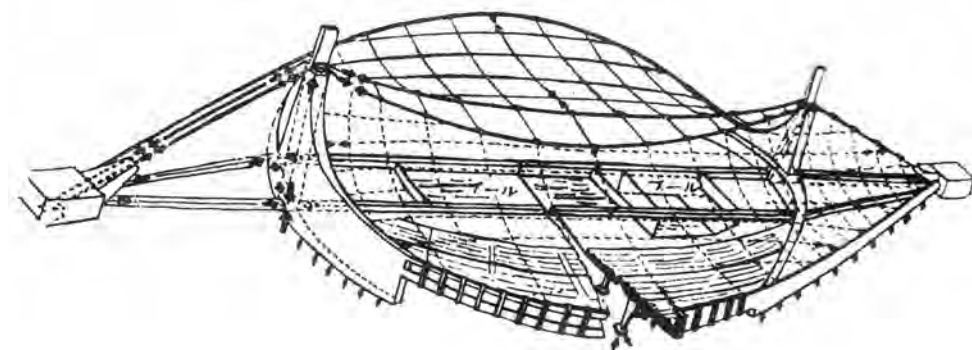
Конструктивная схема павильона Национального стадиона в Токио, арх. К.Тангэ (сжимающие усилия воспринимаются скрытыми под землей мощными железобетонными стержнями)
